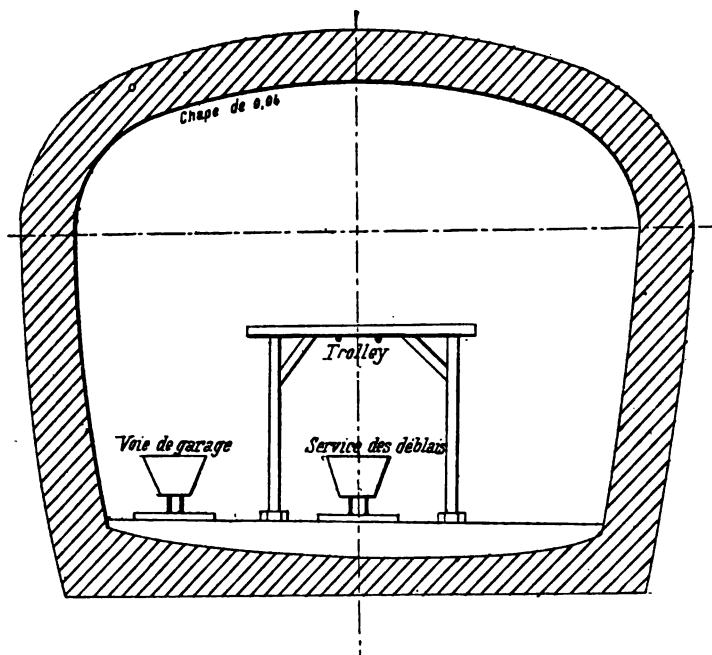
Premier bouclier (Reuilly). Coupe transversale sur la partie achevée.
